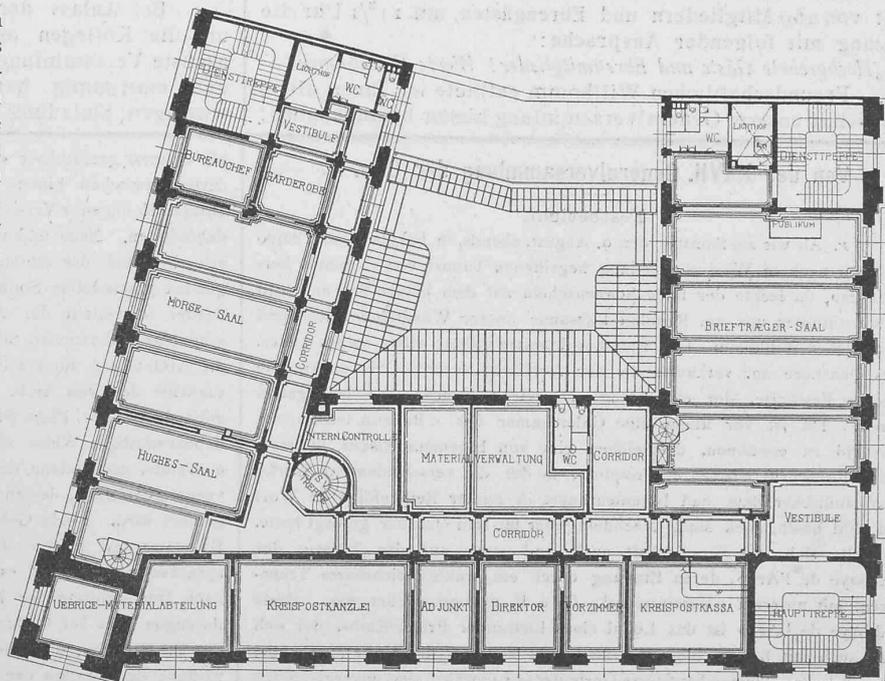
Grundriss vom I. Stock. — Masstab 1 : 500.
